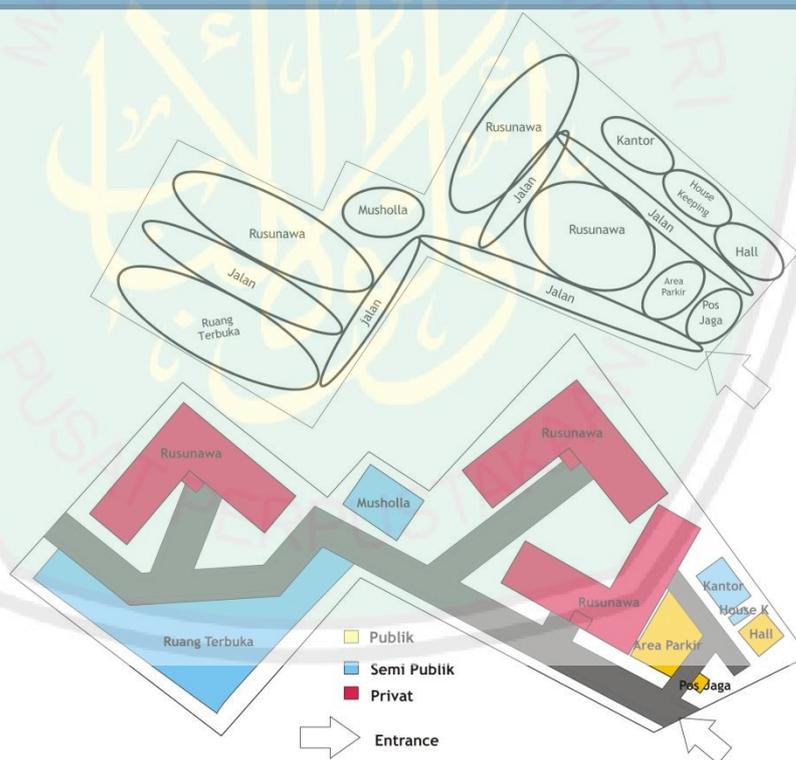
Bubble Diagram dan Blok Plan Rusunawa
